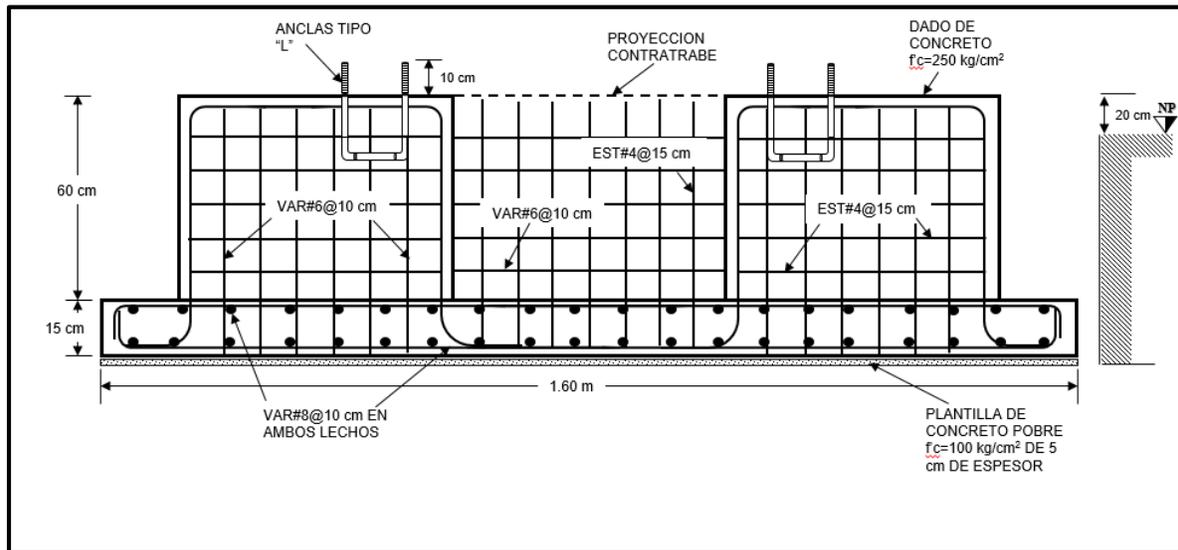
Corte del armado de dados y contratrabe de Zapata Aislada parte de la Cimentación de la Estructura Mayor
